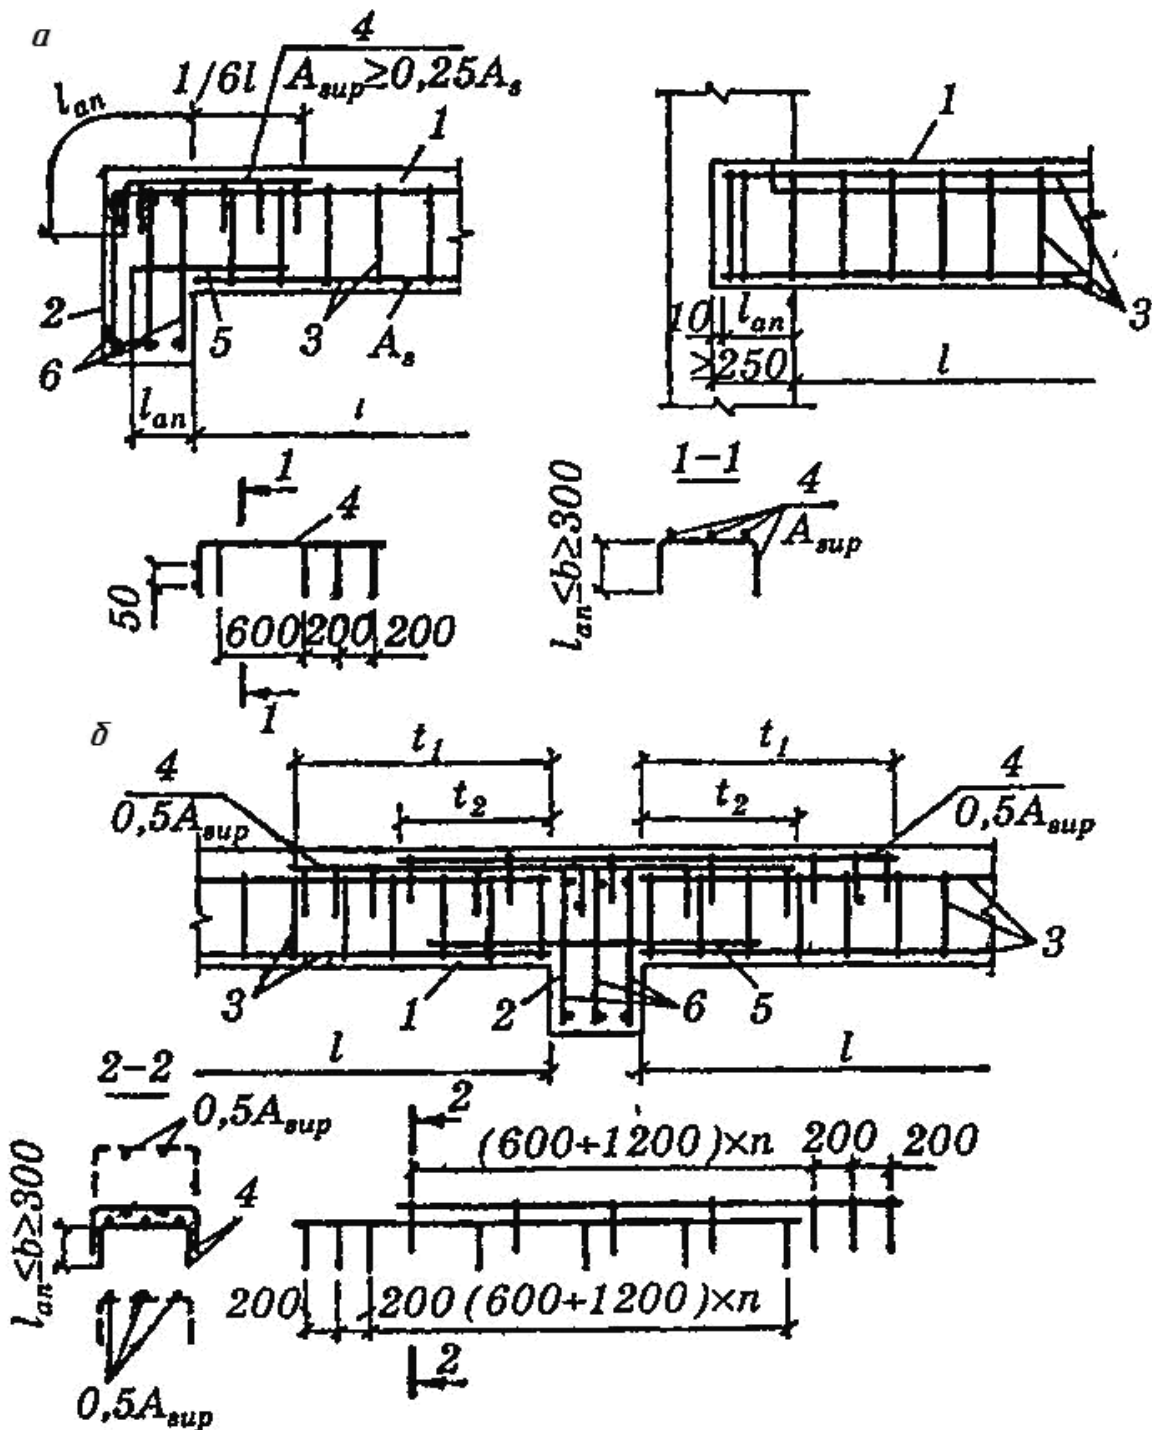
Армирование монолитной неразрезной многопролетной второстепенной балки плоского ребристого перекрытия: *a* – крайние опоры; *б* – средняя опора: 1 – второстепенная балка; 2 – главная балка; 3 – пролетная арматура второстепенной балки; 4 – опорная сетка второстепенной балки; 5 – стыковой стержень диаметром d_s ; 6 – пролетная арматура главной балки; t_1 – по расчету, но не менее $1/3 l$; t_2 – по расчету, но не менее $1/4 l$
